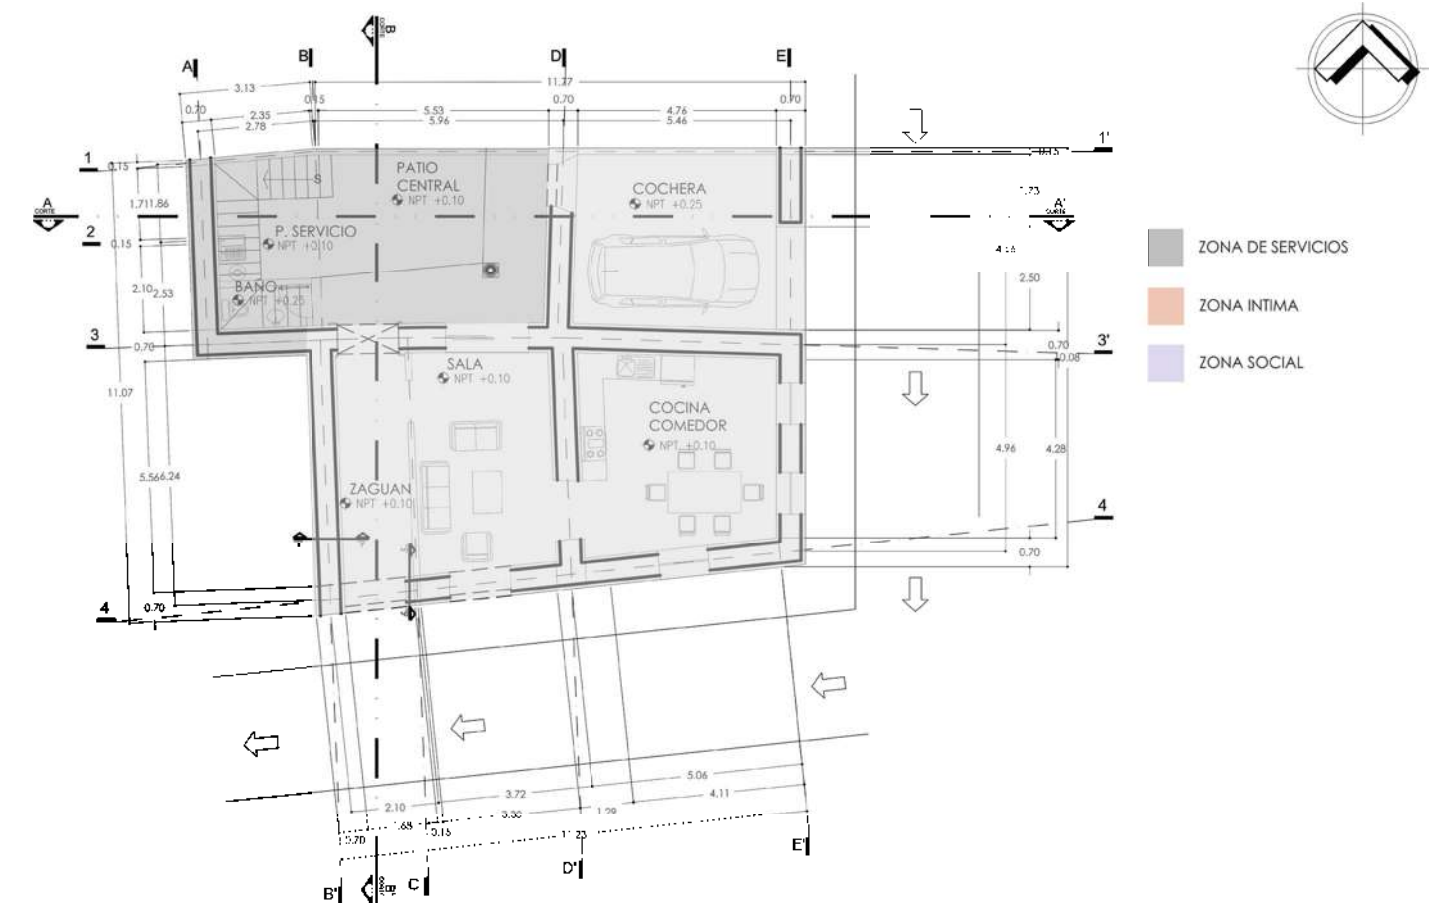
Análisis de Zonas Planta Baja, Ilustración: Teresa García
